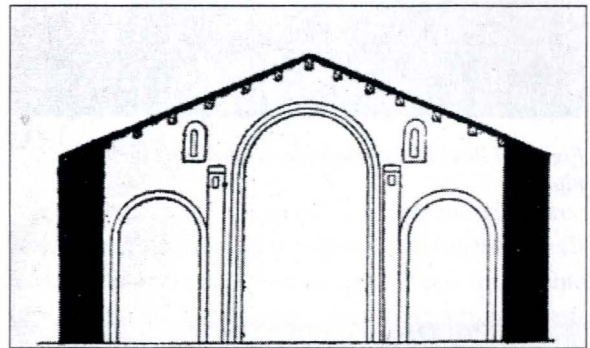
Cubierta de madera paralela al eje de la nave
